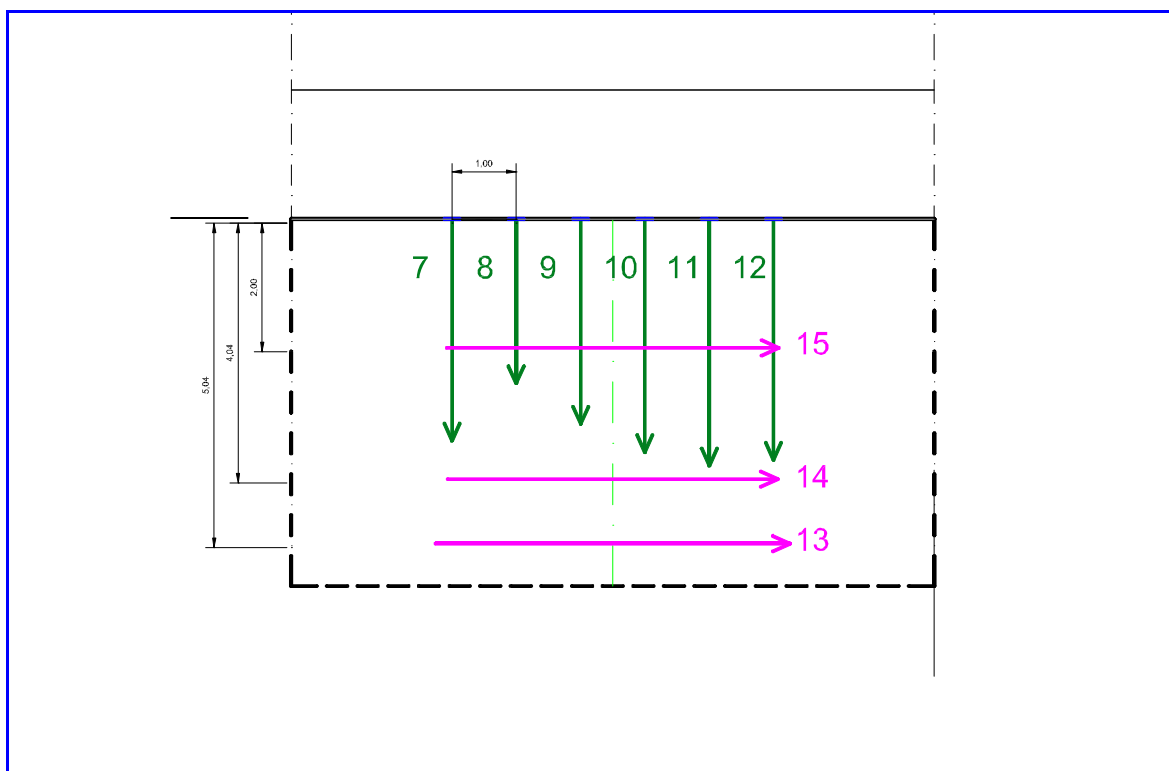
SP 14 - km 10+130 - Prospetto dell'area di prova
